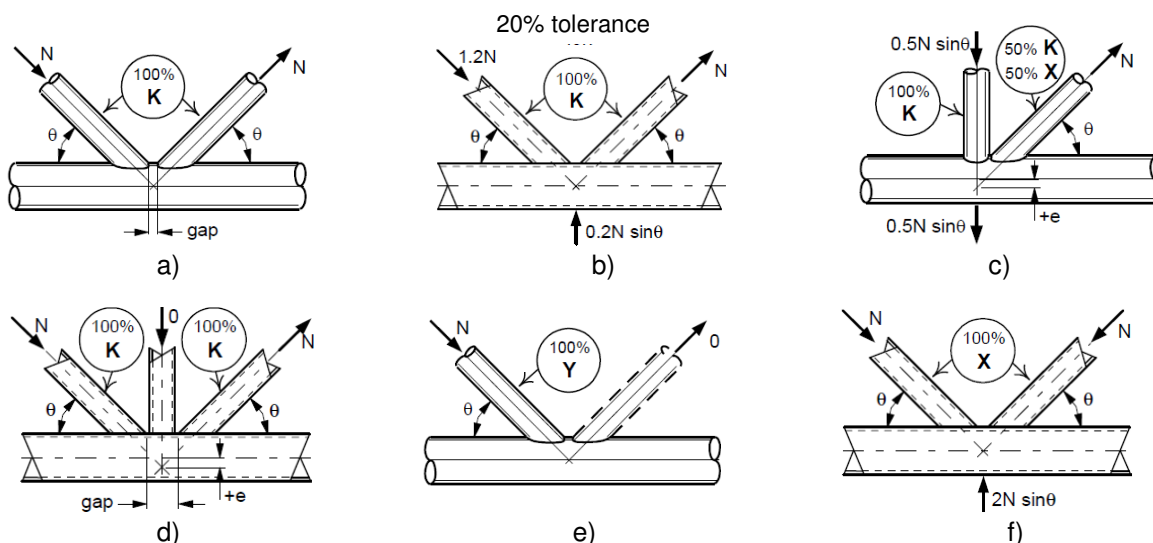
Základní uspořádání styčníků dutých průřezů (převzato z [44])
